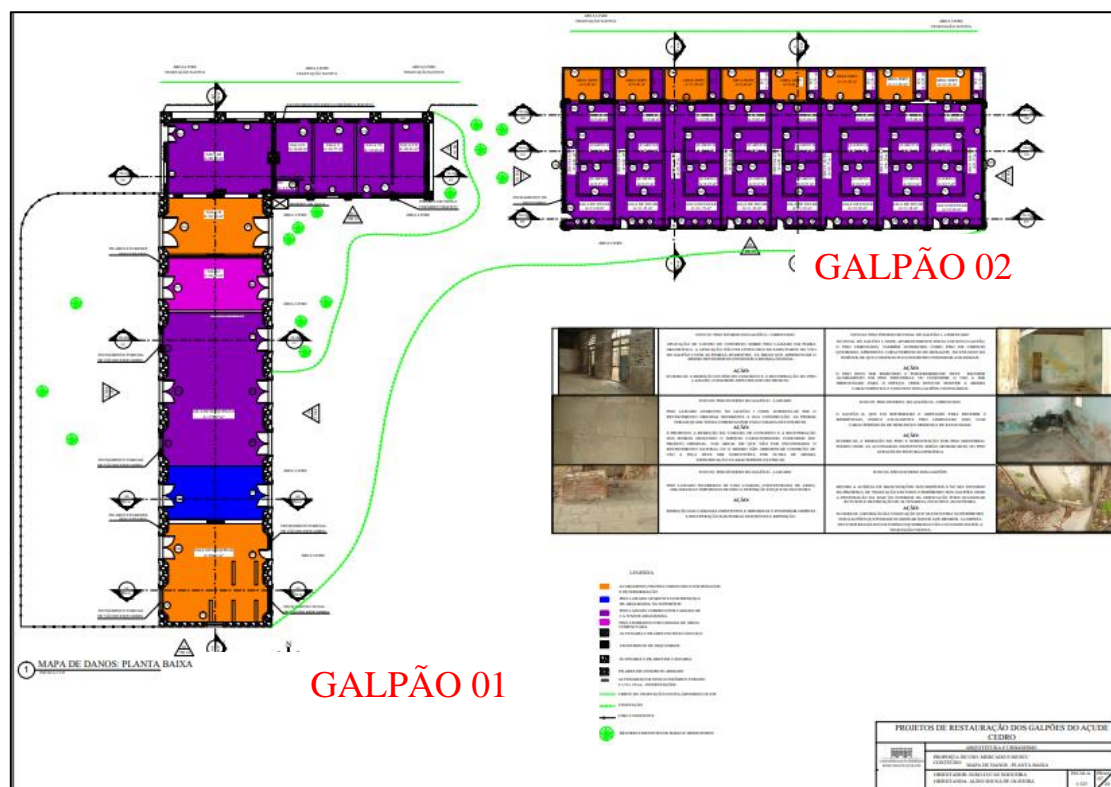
Planta baixa geral – Galpão 01 e 02:
